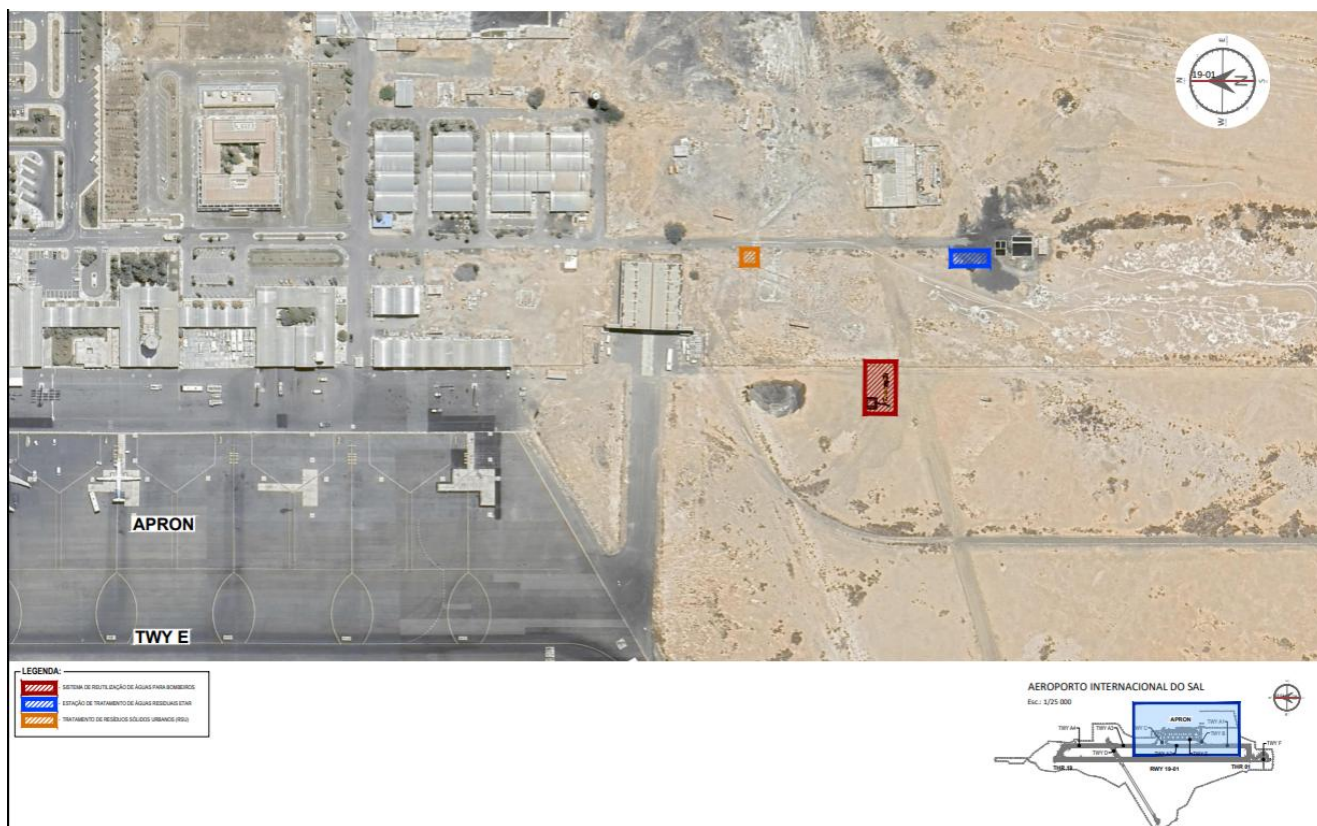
| Trabalhos Ambientais Fase 1-B – Localização - Pormenor
